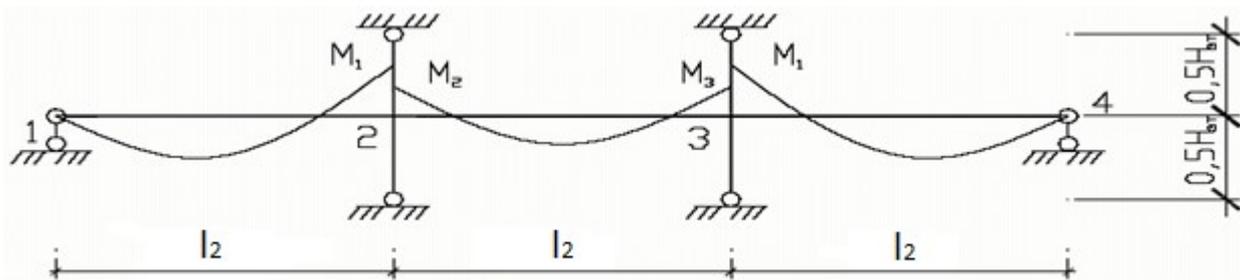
Схема расположения опорных моментов (цифрами обозначены номера опор, размеры условные).
